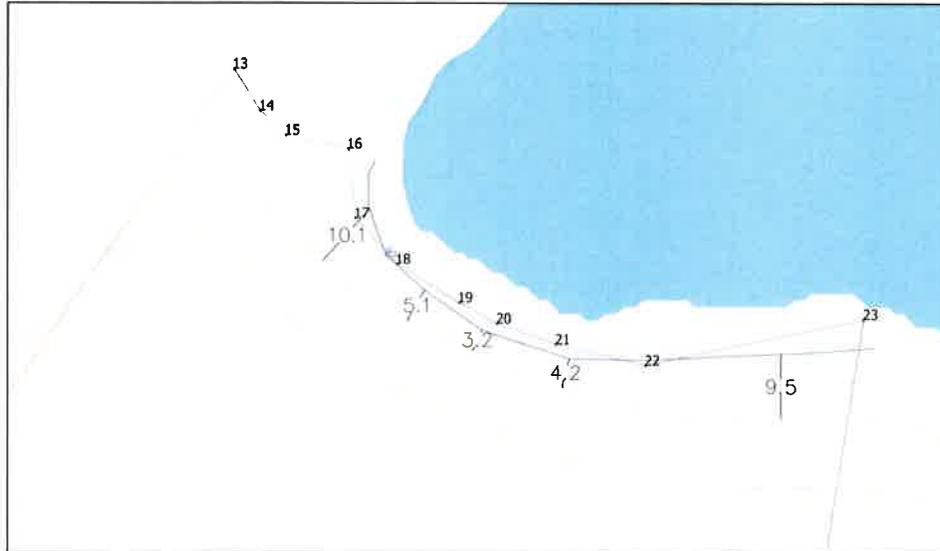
Distancia entre ribera sur y vía proyectada, según elementos del PRCC.
